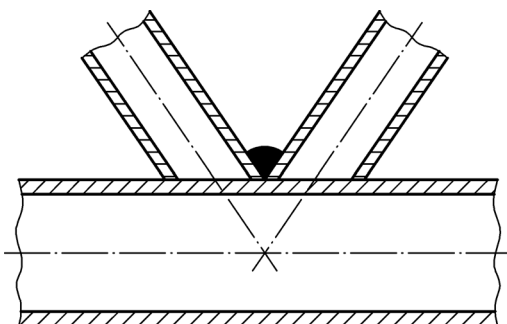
Підготовка та підгонка контурів зварного шва порожнистого профілю для стикових з'єднань під кутом
